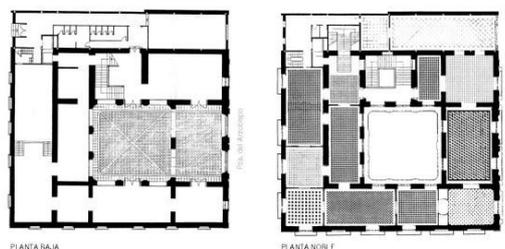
Planta baja y planta noble del Palacio. Fuente: Manuel Portaceli Arquitectos
